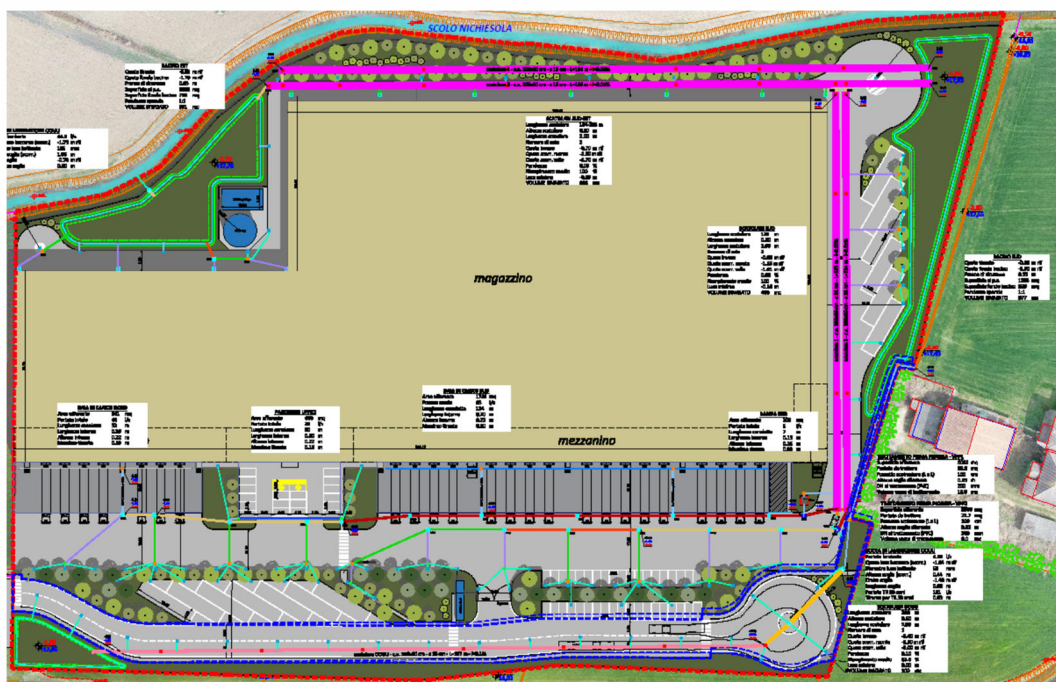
Rete di invaso e drenaggio per le opere private e le opere pubbliche.
